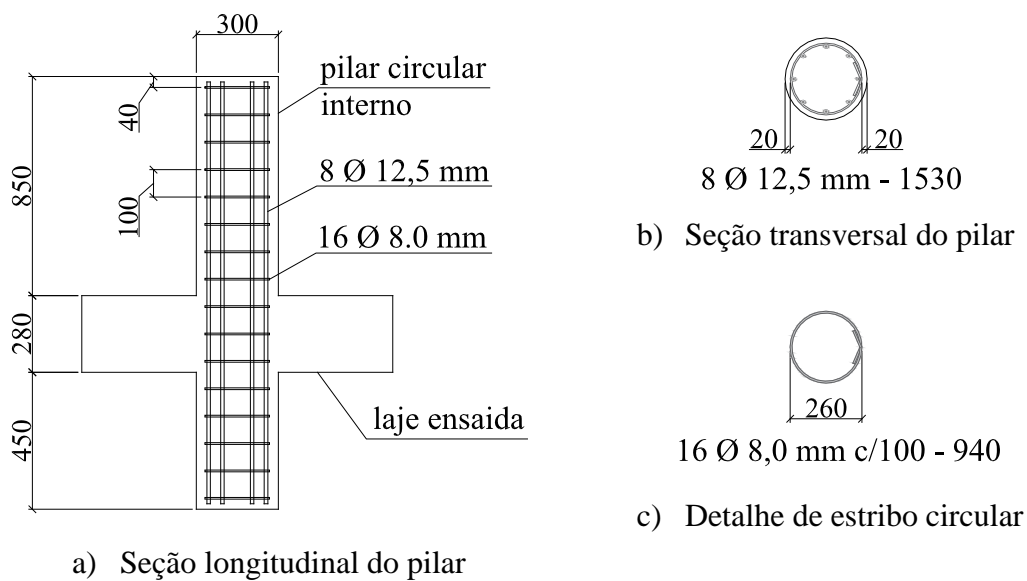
Detalhe da armadura dos pilares (cotas em mm).
